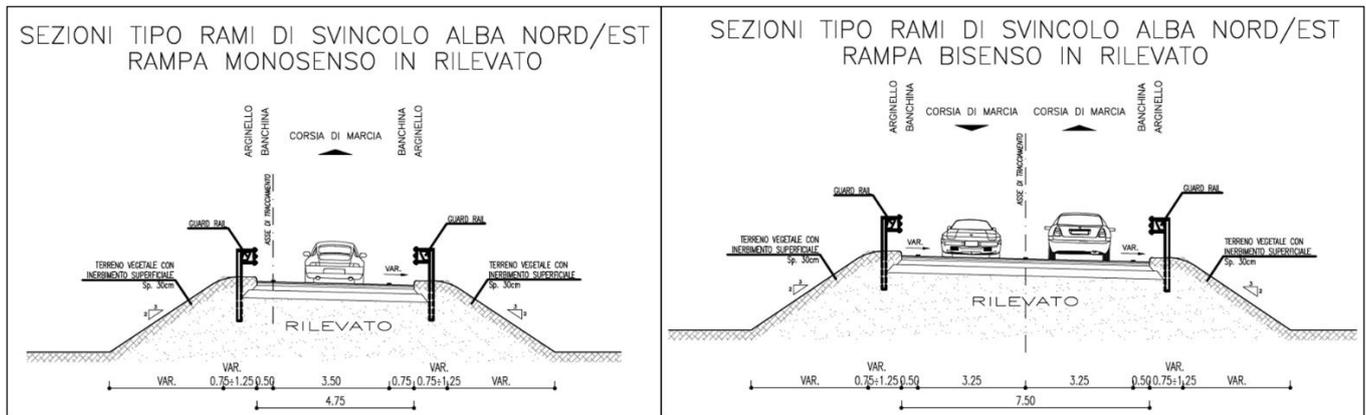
Sezione tipo asse stradale lungo le rampe degli svincoli
